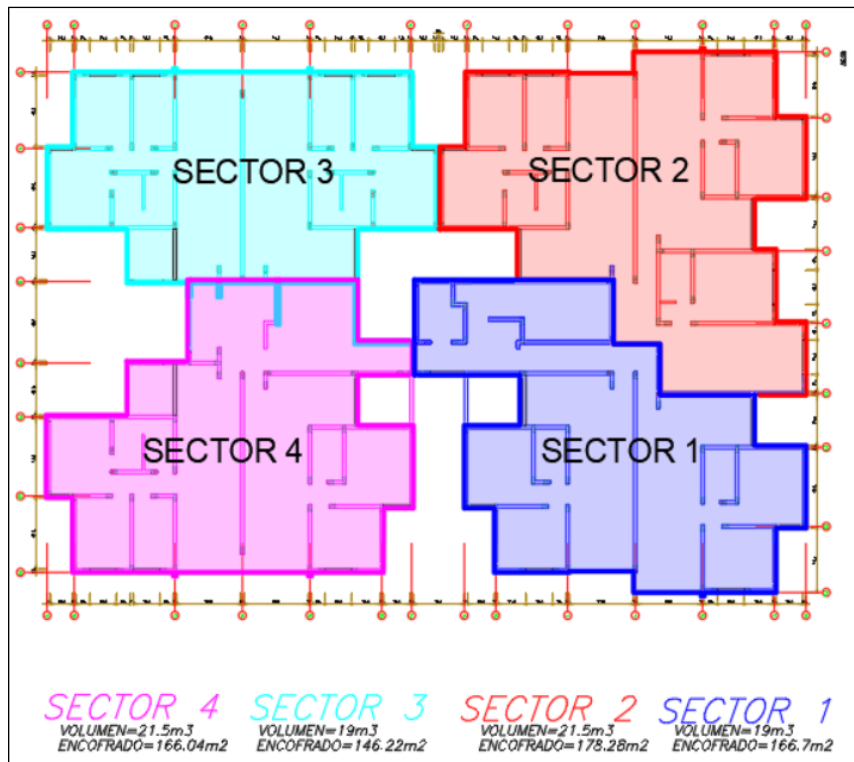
Sectorización – Metrados de Encofrado, Concreto - Losas
